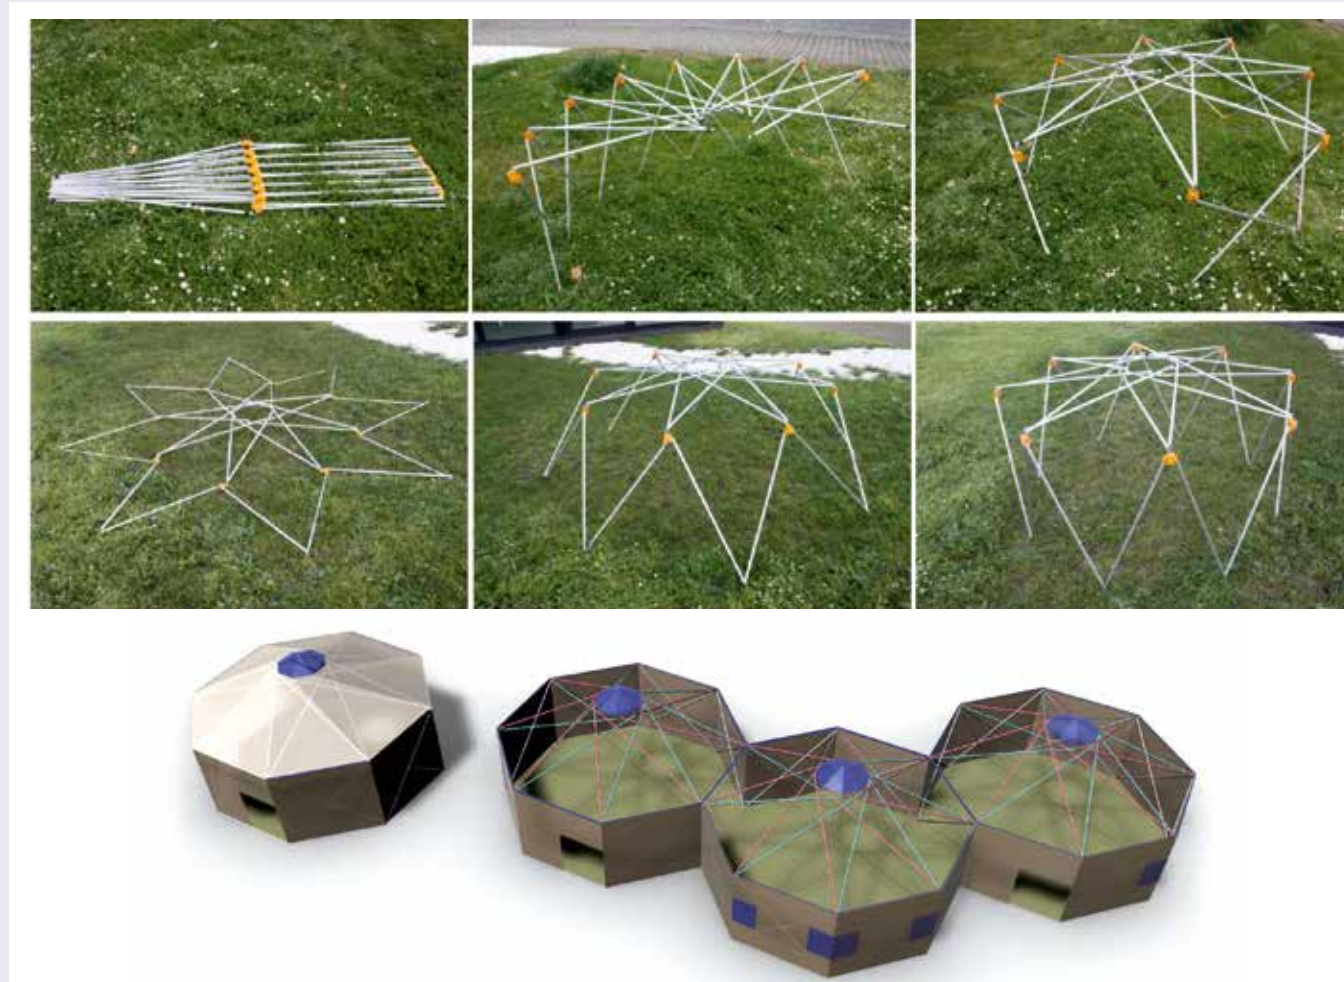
Modelos de yurtas desplegables de barras con apoyos múltiples.
